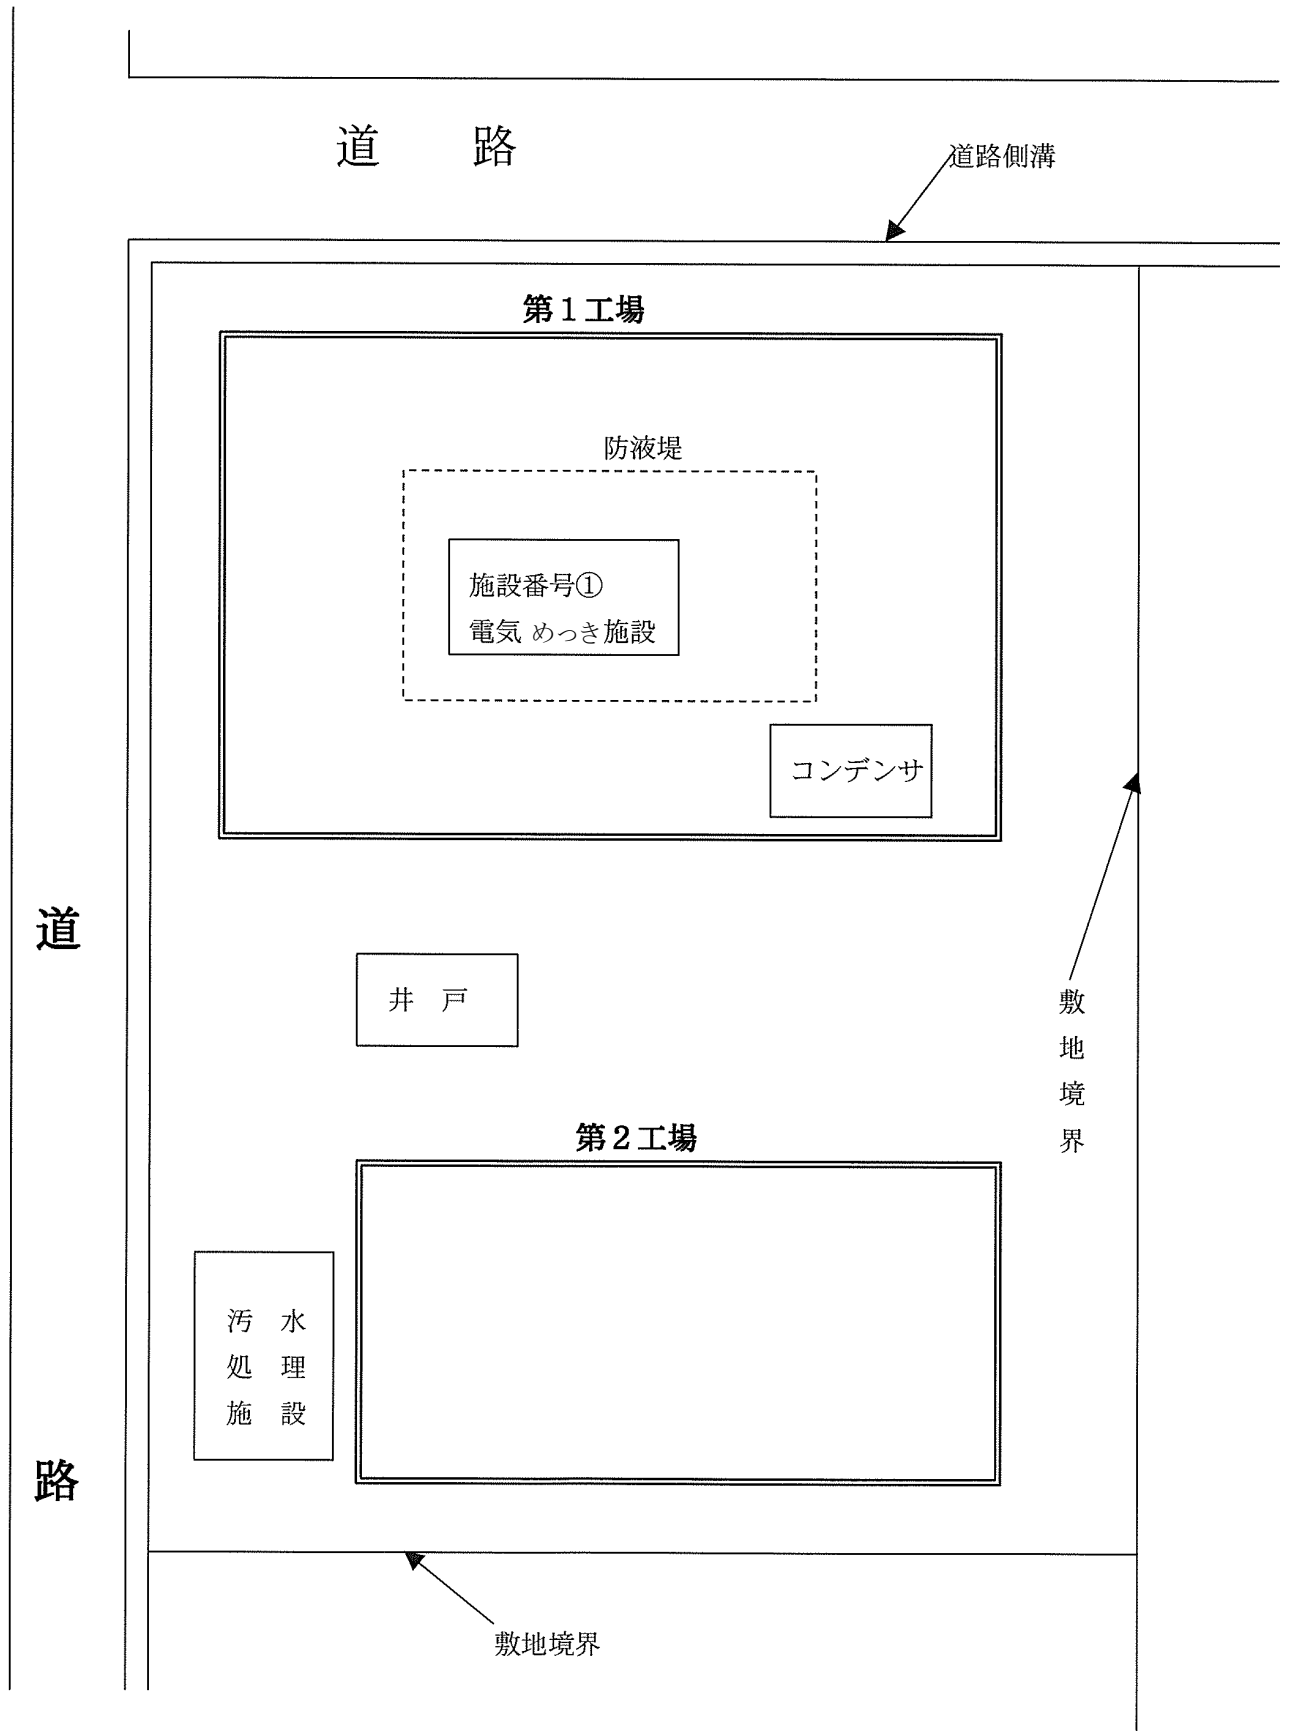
配置図（実際は平面図にできるかぎり正確に記載する）
